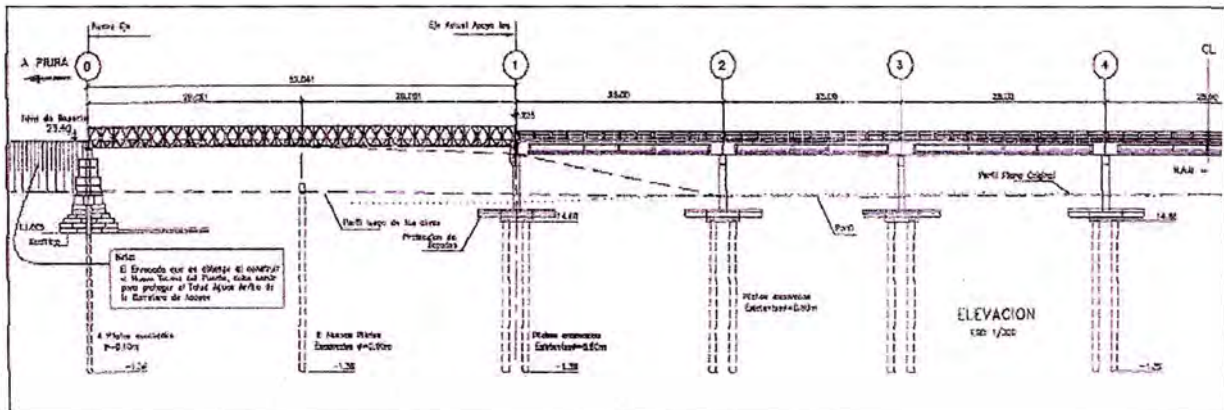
Elevación del tramo nuevo entre ejes 0 y 1, se observa la estructura metálica a ser cambiada y la ubicación del nuevo pilar intermedio en el eje 0.5.
